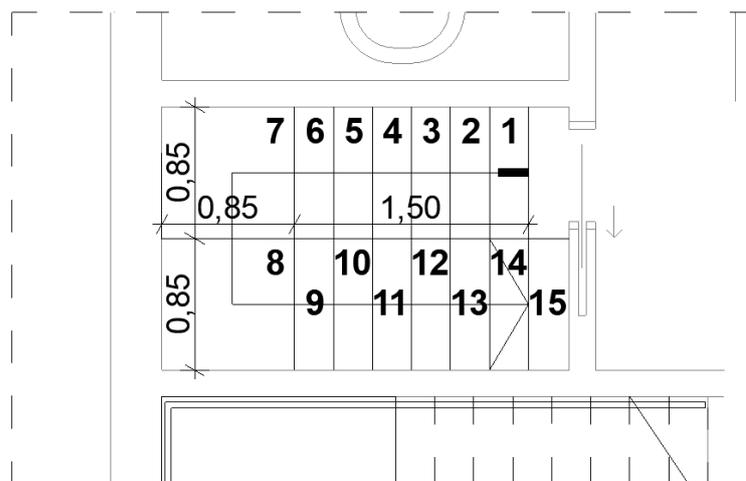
Anteproyecto arquitectónico: circulación vertical secundaria.
